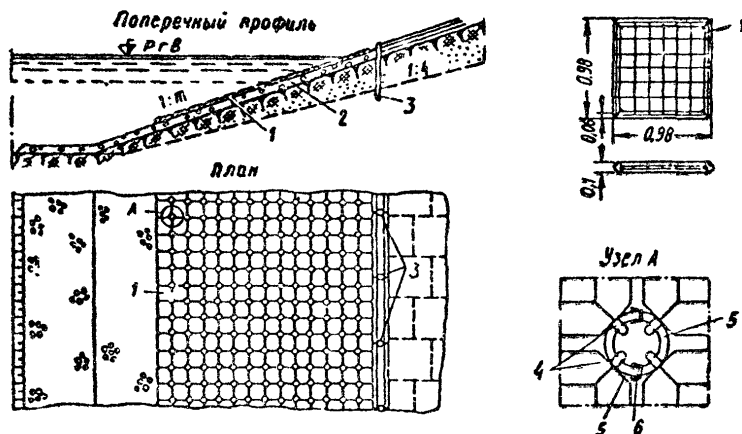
Конструкция крепления откоса гибким тюфяком из железобетонных плит:
